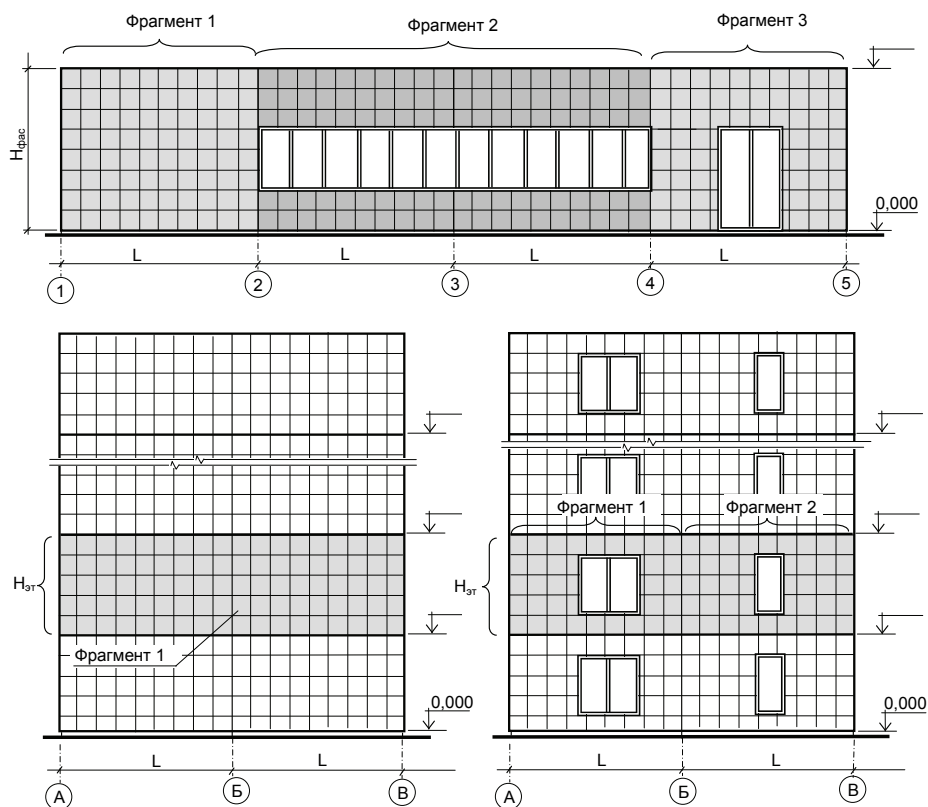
Возможные варианты разбиения фасада здания (а) или промежуточного этажа (б) на отдельные фрагменты
